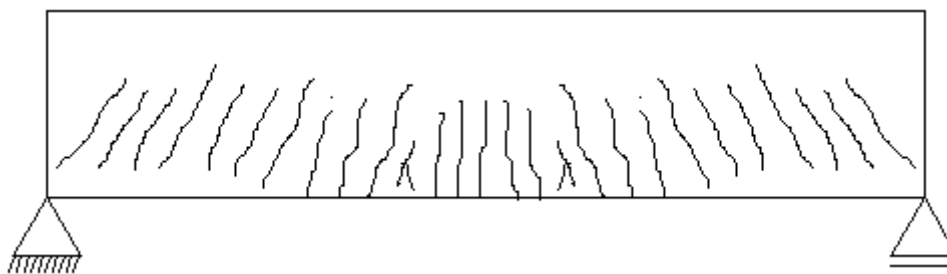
Viga com estado de fissuração próximo à ruptura (Fonte: autor).
